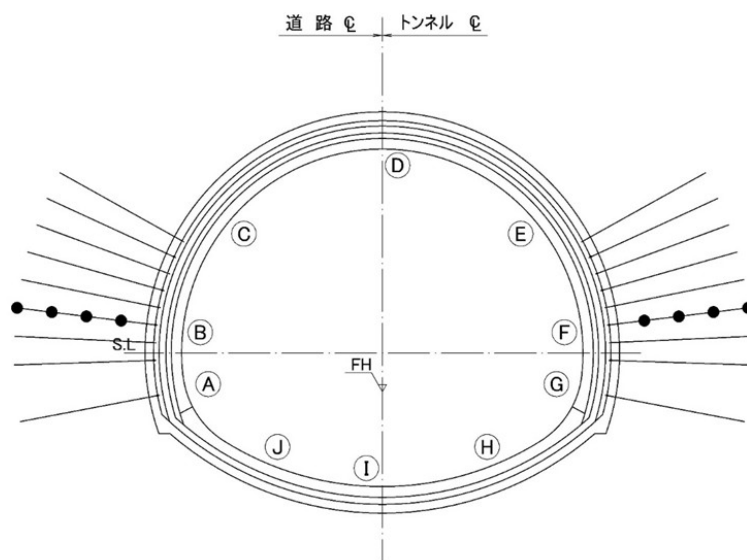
音中トンネル 計測 B 断面図 (P=8, 268)
